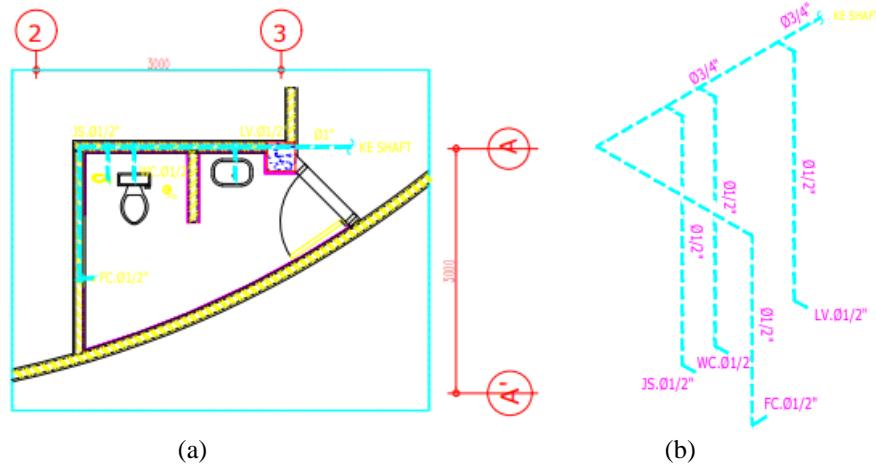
(a) Denah instalasi air bersih lantai 2, (b) Isometrik instalasi air bersih lantai 2
